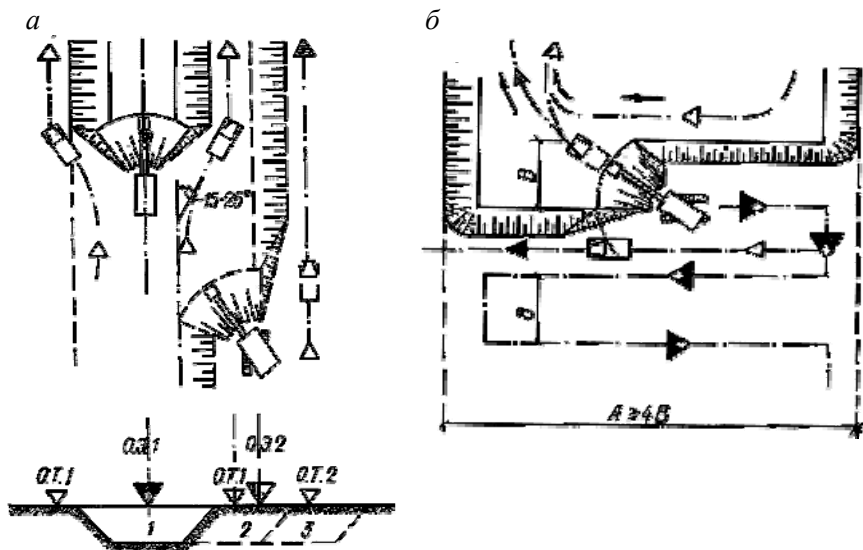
Схемы проходок экскаватора «обратная лопата»:
